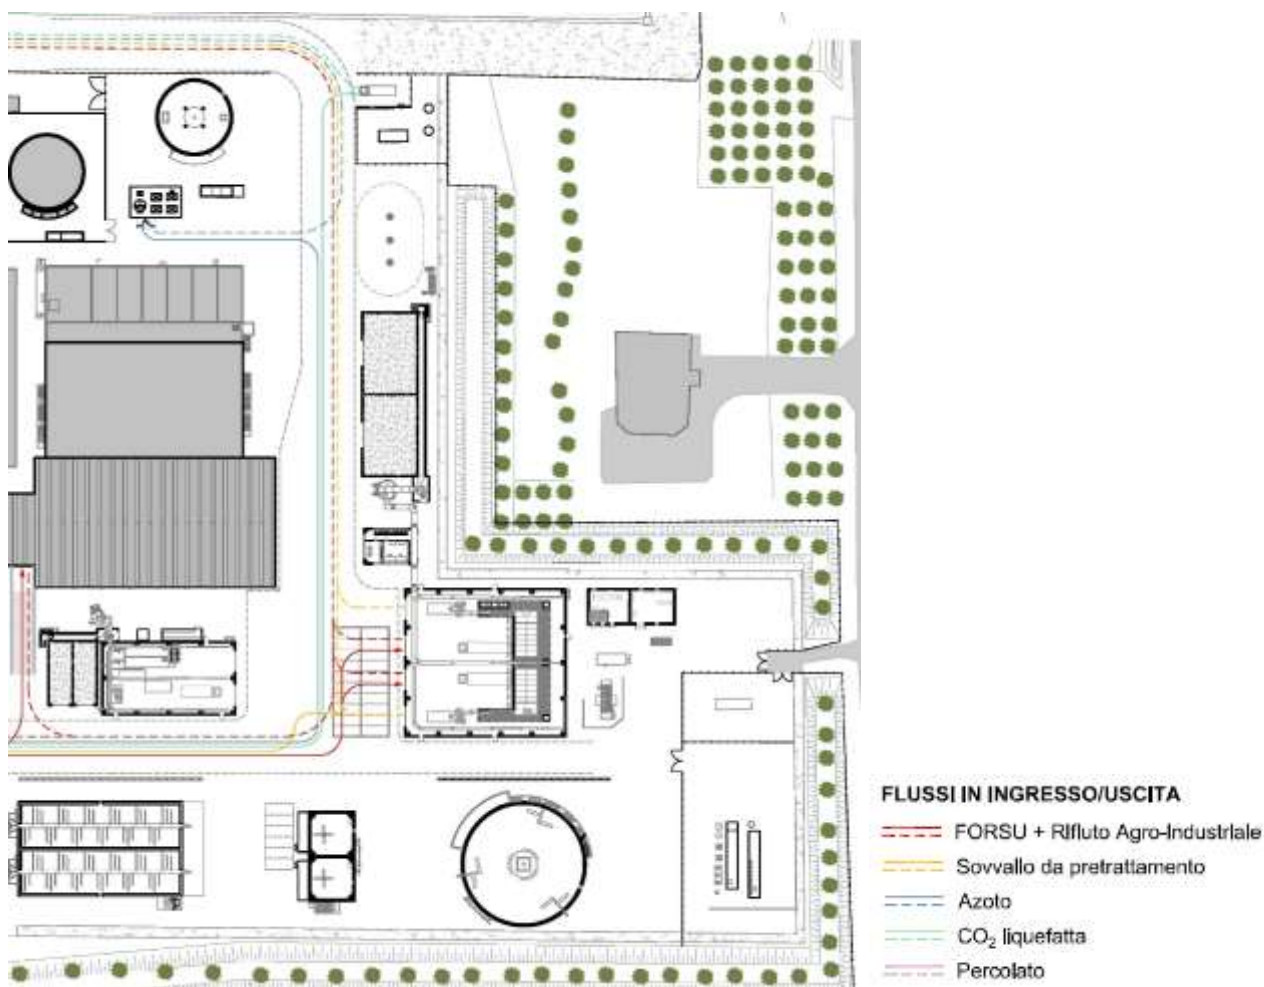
Estratto Planimetria con indicazione della viabilità interna all'impianto [TEC_006]
